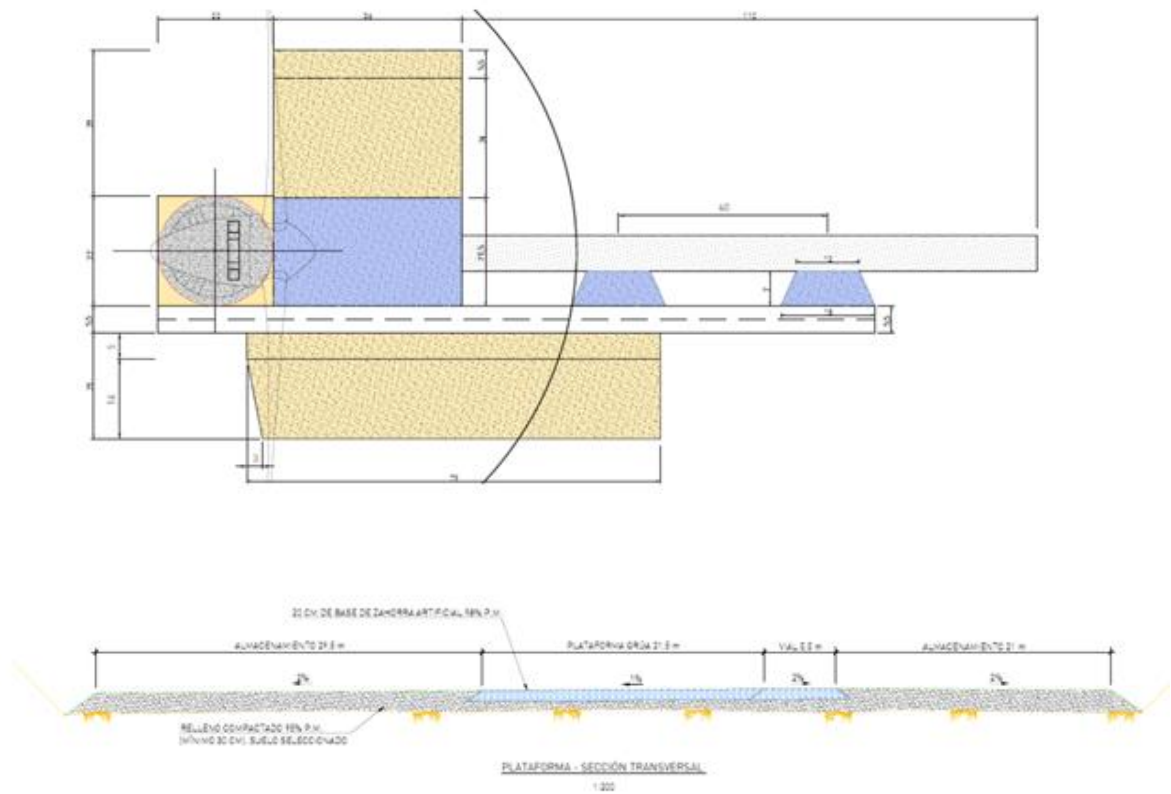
Planta y sección transversal de plataforma de montaje y aerogenerador.
